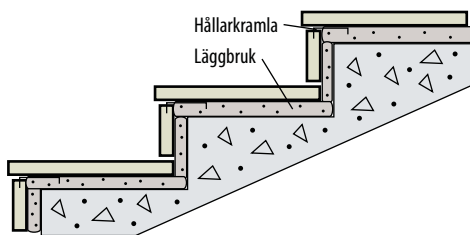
Beklädnadstrappa monterad i bruk på stomme av betong. Typkonstruktion T4
